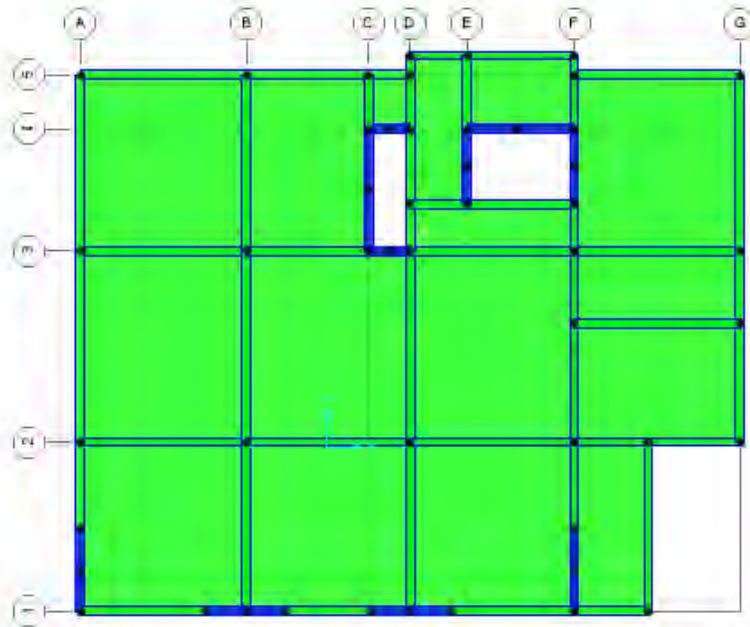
Vista en planta del 4to piso del Modelo 01. Fuente: propia.
